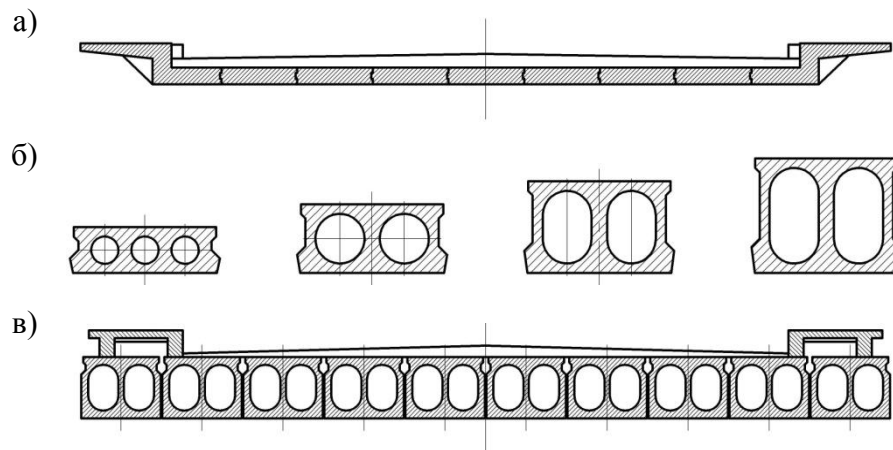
Залізобетонні плитні прогонові будови: а – із суцільних плит; б, в – з порожнистих плит.
